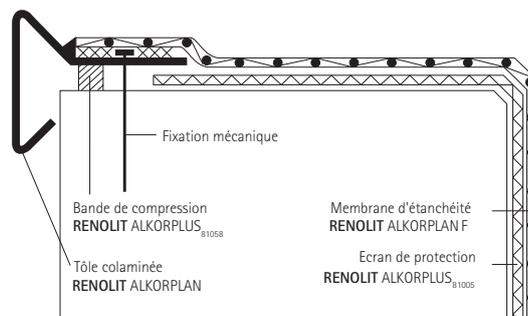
Etanchéité au vent par pose en indépendance d'autres membranes RENOLIT ALKORPLAN.
